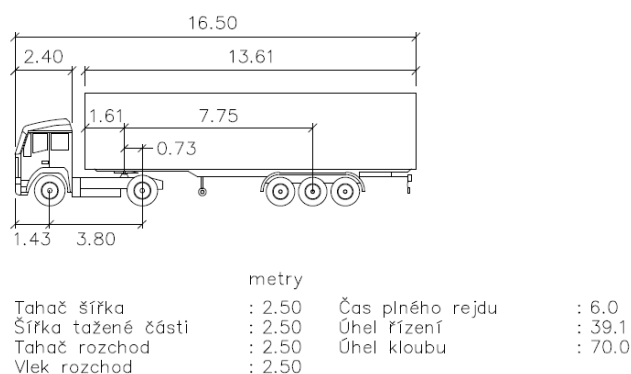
Náhrada standardních jízdních souprav za EMS jízdní soupravy [12]
